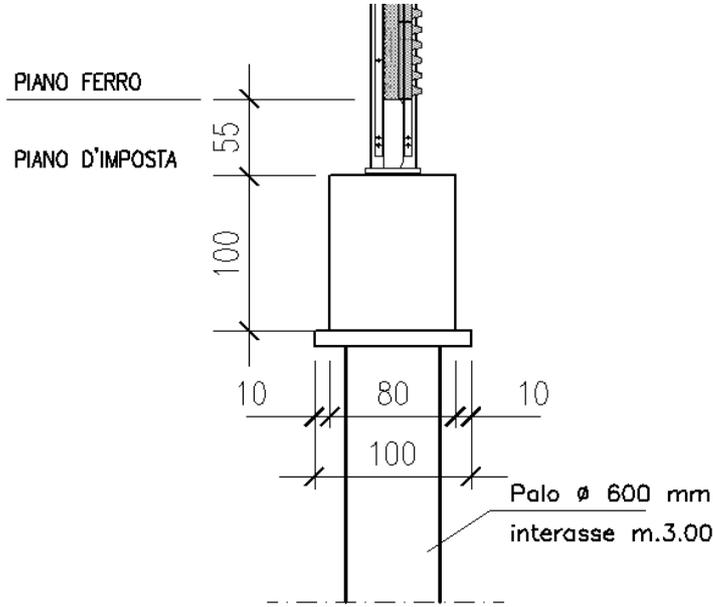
sezione fondazione di linea BFA (BA01÷BA15 e BA18÷BA20)
